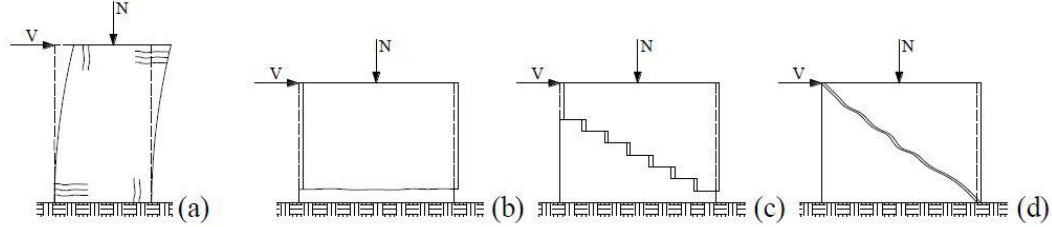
Modos de rotura no-plano: a) flexão-compressão; b) corte com deslizamento horizontal; c) corte com deslizamento diagonal; d) corte com fissuração diagonal [33]
